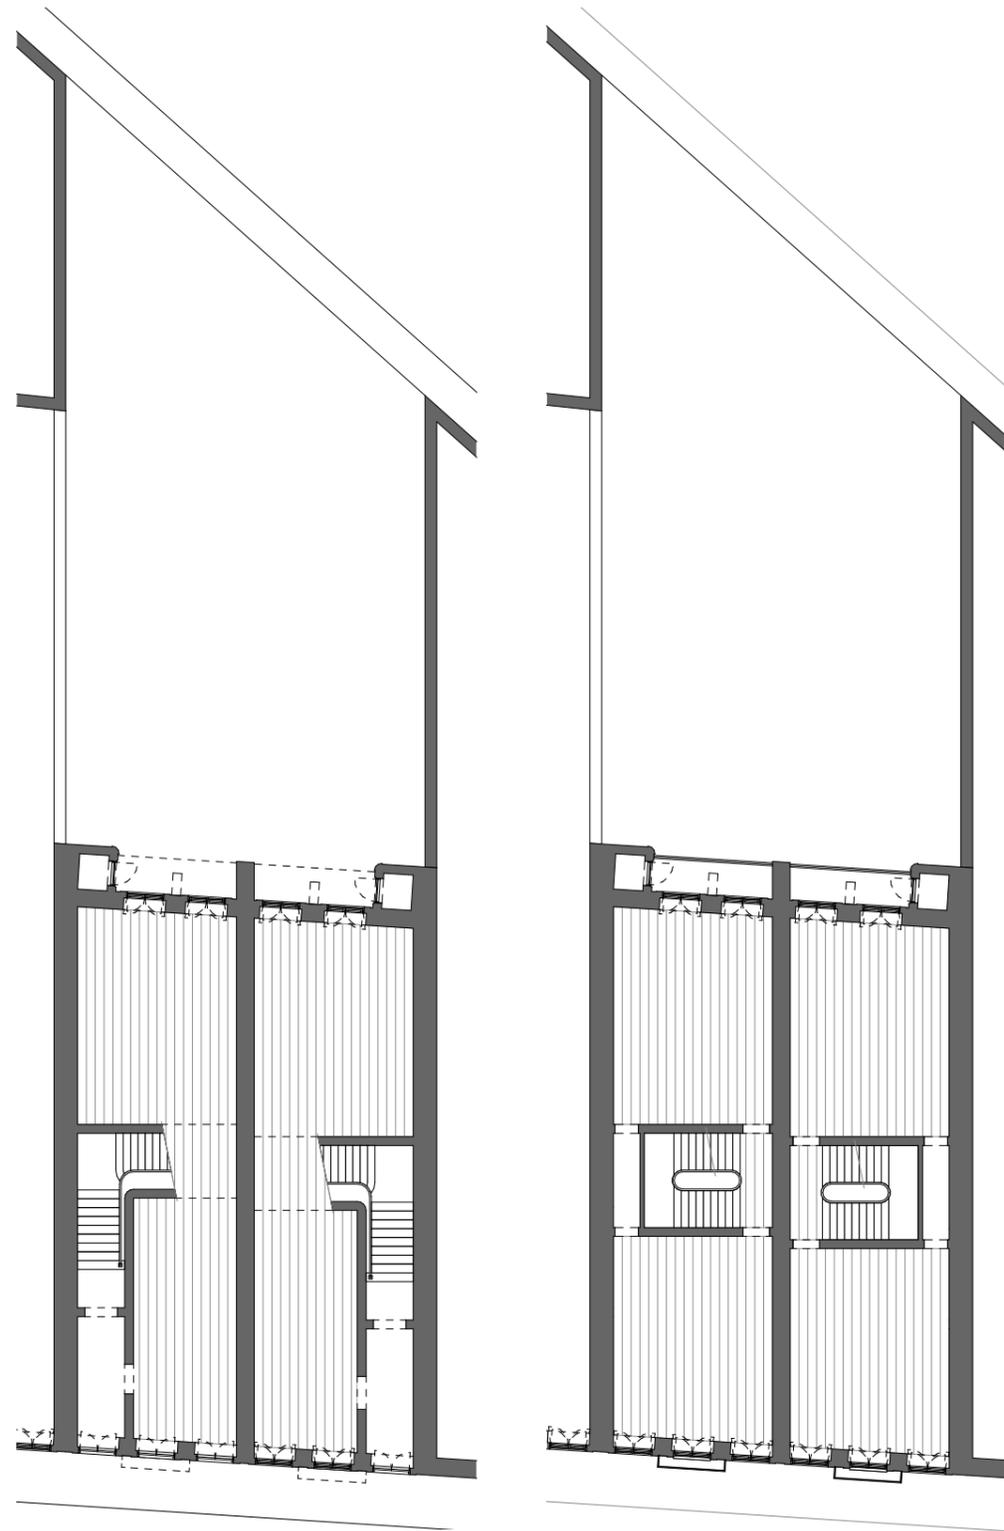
e 105 Planta de levantamento do Ré-do-chão e Primeiro Pavimento
